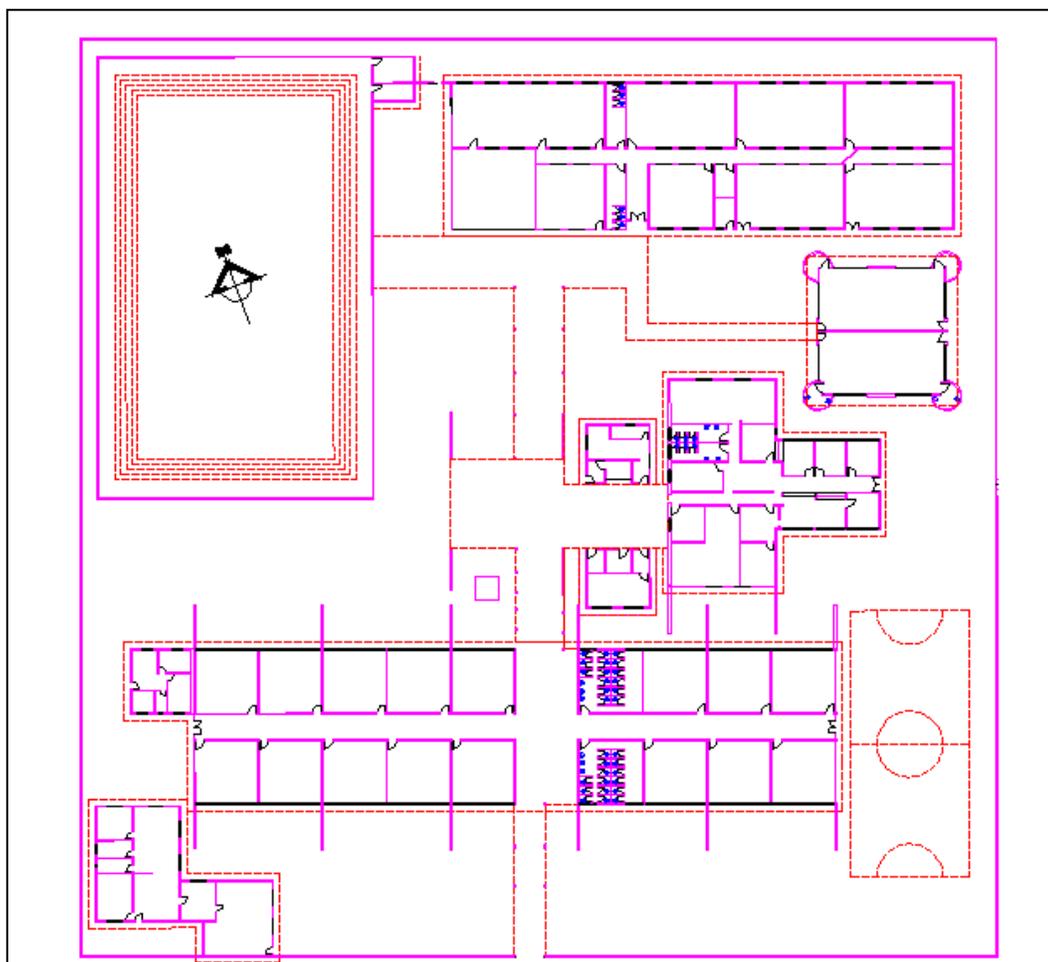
PLANTA BAIXA COLÉGIO ESTADUAL ERON DOMINGUES.
